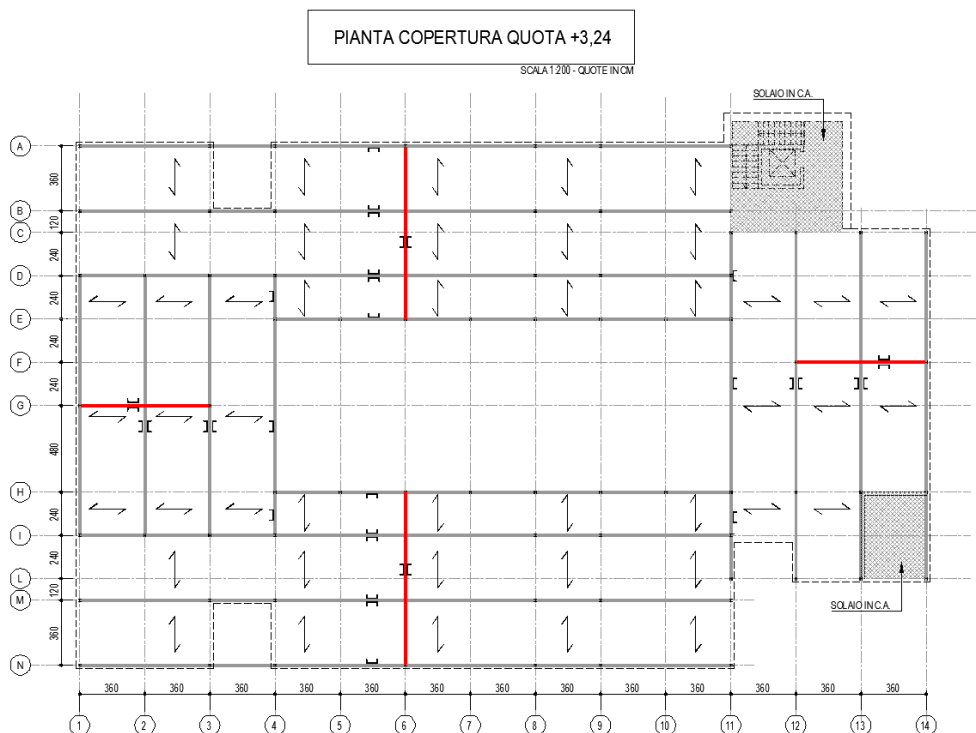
Pianta interventi di irrigidimento - copertura
